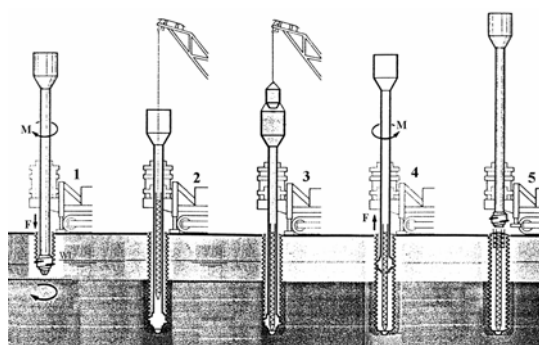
Последовательность устройства свай «Atlas»: 1, 2 – погружение специальной стальной трубы в грунт ввинчиванием до проектной отметки; 3 – погружение арматурного каркаса внутрь трубы, бетонирование скважины; 4 – подъем труб с обратным вращением; 5 – погружение короткого внешнего каркаса
